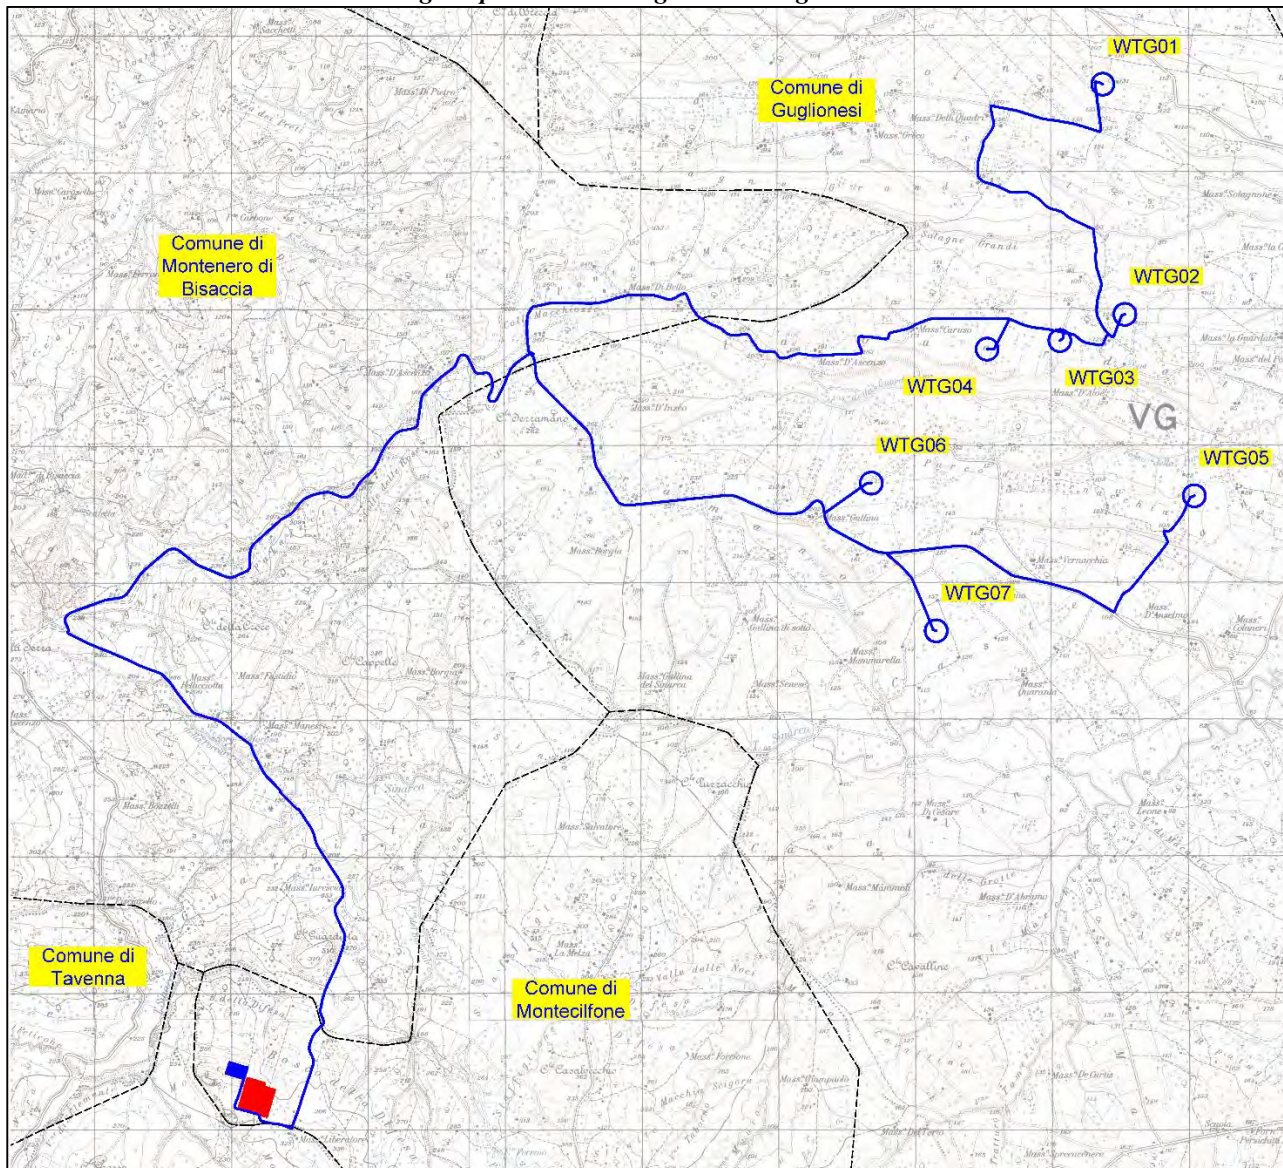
stralcio planimetrico su IGM del layout di impianto
